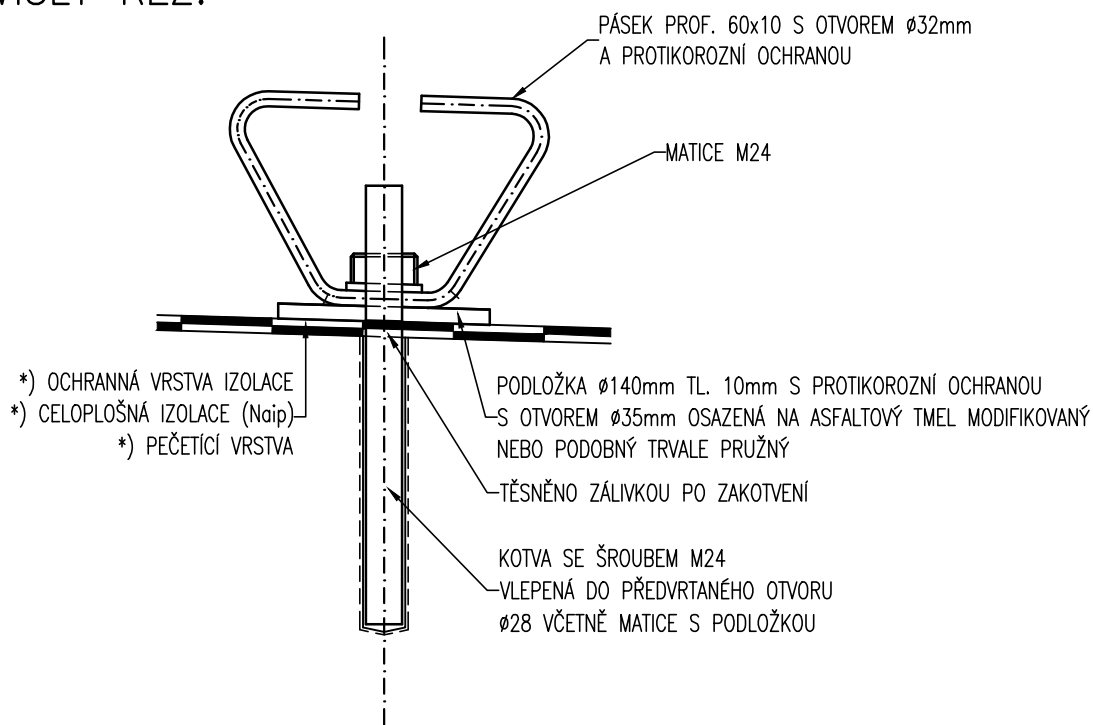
## DETAIL ZVÝŠENÉHO OKRAJE NOSNÉ KONSTRUKCE 1:5
